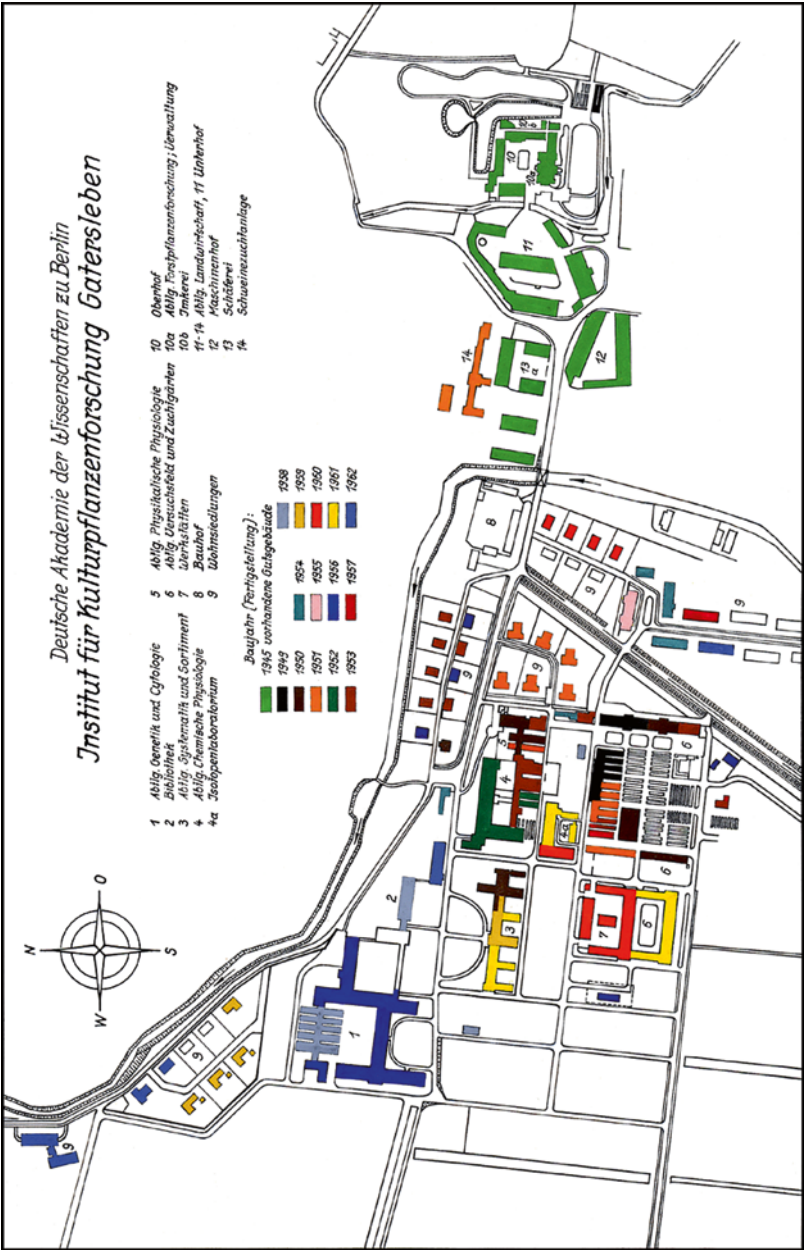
Aufriss der Institutsgebäude und ihre Bauzeit; Plan von 1962/1963 (IPK-Archiv)
